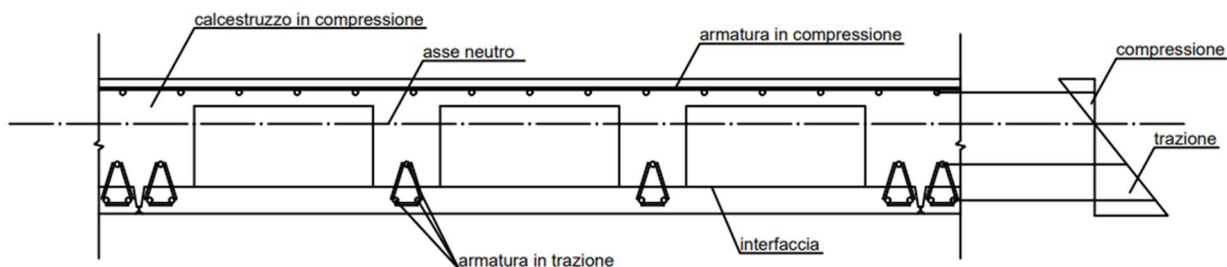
sezione in campata di una lastra Predalles con andamento delle tensioni
